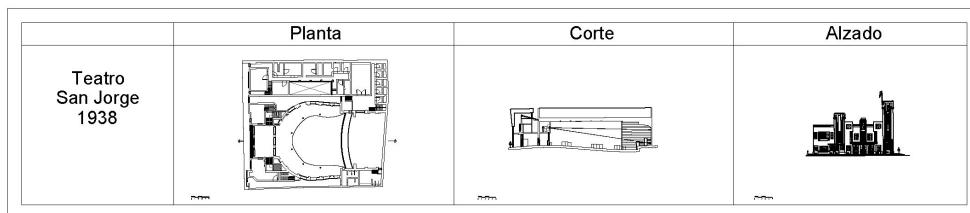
Teatro San Jorge en planta, corte y alzado.
